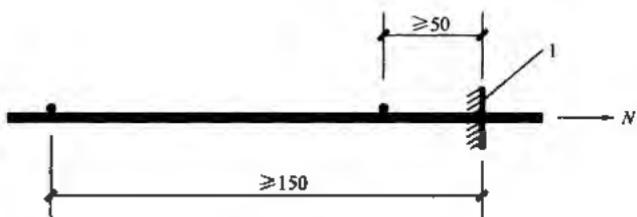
受拉光面钢筋焊接网的锚固
